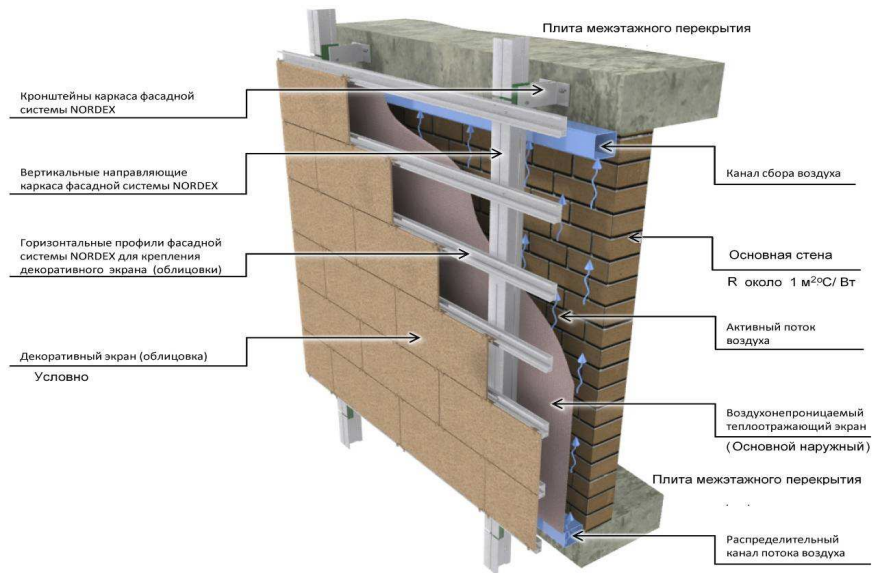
Навесная фасадная система NORDEX с активным энергосбережением (вариант крепления в межэтажные перекрытия)
